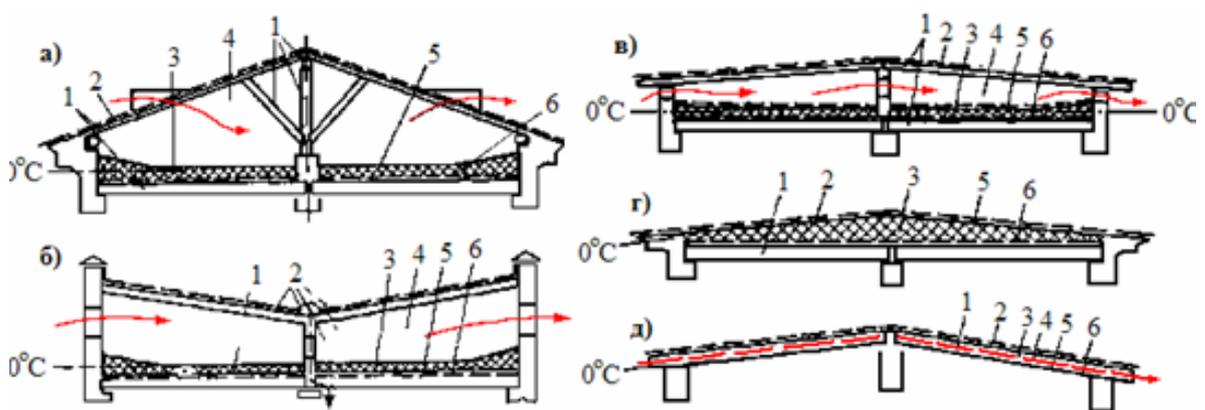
Варианты конструктивных решений крыш зданий: чердачные: а – с наружным водоотводом; б – с внутренним водоотводом; в – с полупроходным чердаком; совмещенные: (г и д) – 1 – несущие элементы; 2 – кровля, водостоки; 3 – теплоизоляция; 4 – воздушная прослойка, вентиляционные каналы; 5 – защитный слой теплоизоляции сверху, 6 – пароизоляция теплоизоляции снизу
